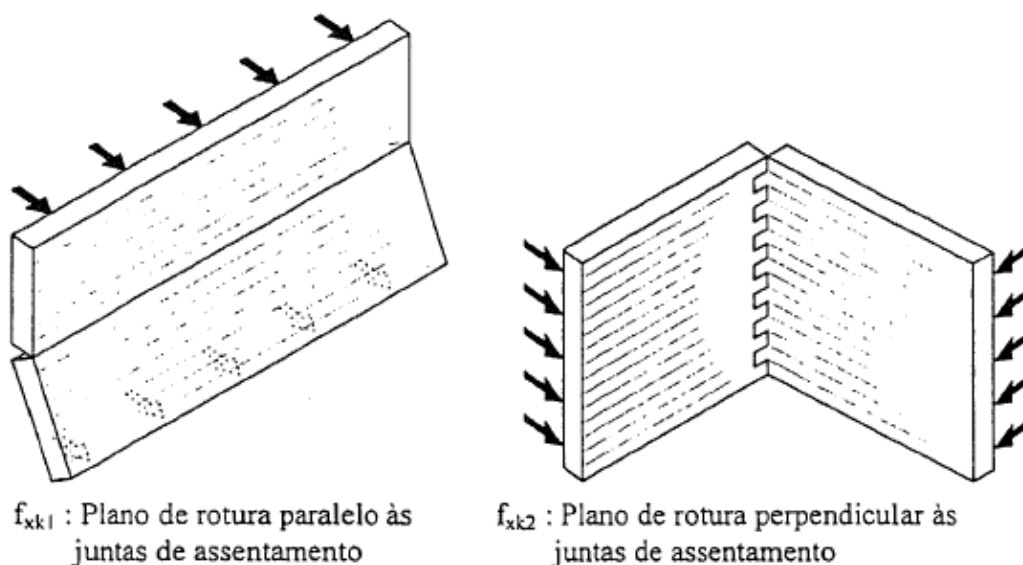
Planos de rotura por flexão de paredes de alvenaria [25]
